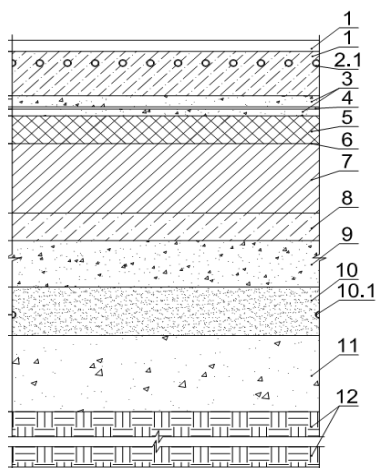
Конструкция основания ледового поля: 1 - слой льда; 2 - плита технологическая с трубопроводами холодоснабжения; 2.1 - трубопроводы холодоснабжения; 3 - выравнивающая стяжка; 4 - гидроизоляционные слои (2 слоя); 5 - утеплитель; 6 - гидроизоляционный слой (1 слой); 7 - плита несущая; 8 - подготовка из бетона; 9 - слой щебня; 10 - песок с трубопроводами защиты грунта от промерзания; 10.1 - трубопровод защиты грунта от промерзания; 11 - грунт уплотненный щебнем; 12 - материковый грунт.
